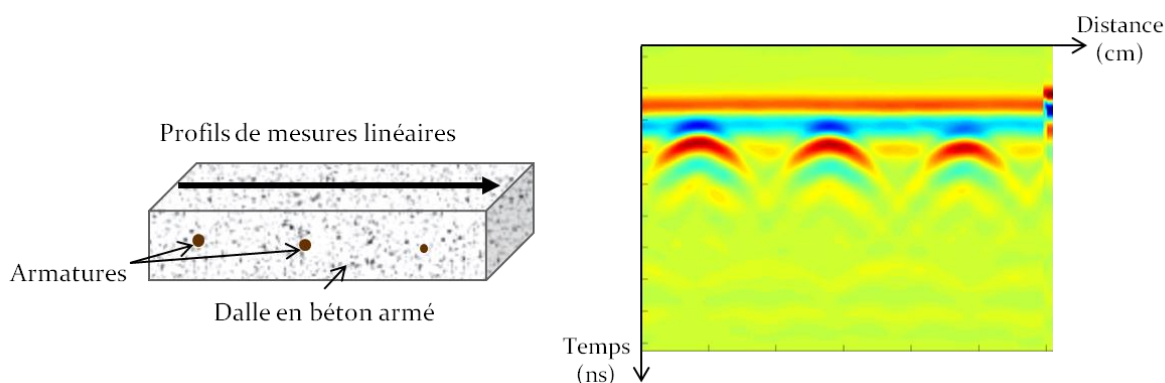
Exemple d'un profil de mesure (B-scan) sur une dalle en béton armé
